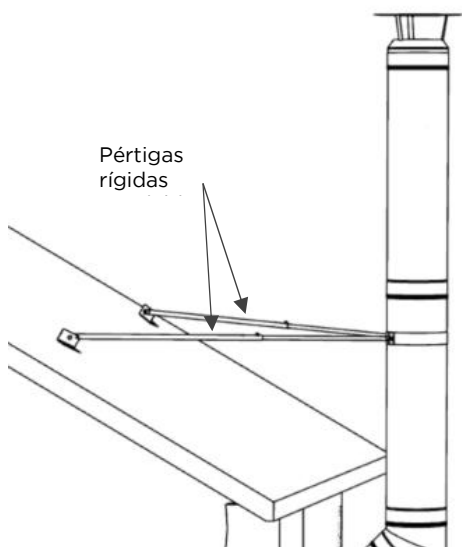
, Abrazadera con doble pértiga telescópica (191)
